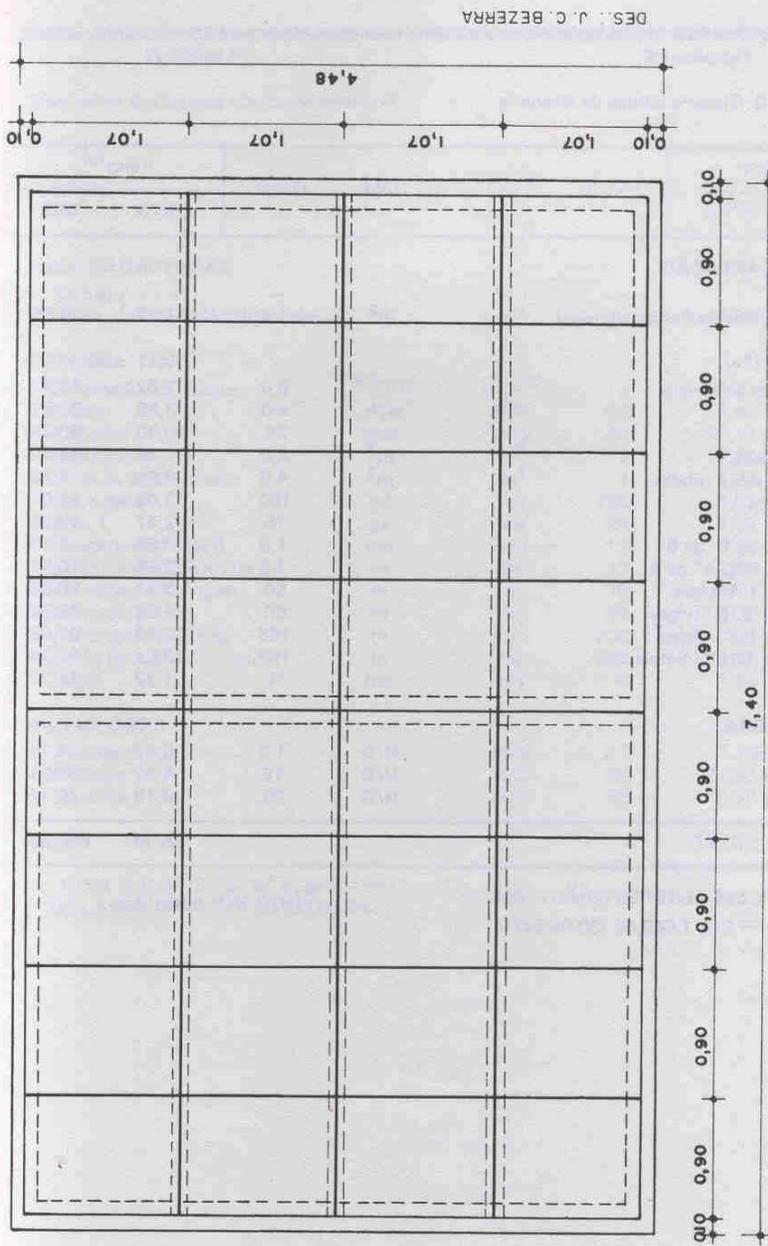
Planta baixa de cisterna retangular de alvenaria com capacidade para 30 m³.
